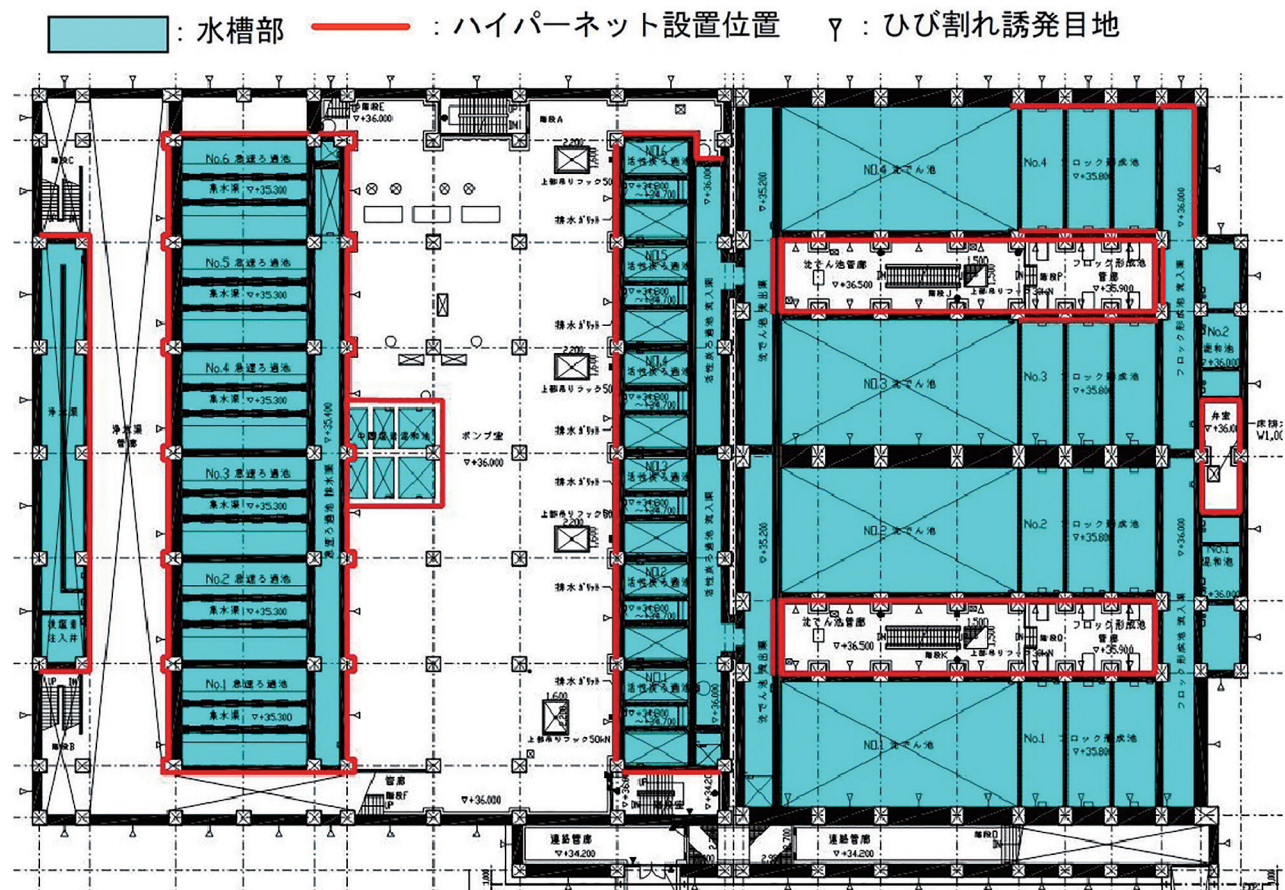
ひび割れ誘発目地、ハイパーネット設置位置図
